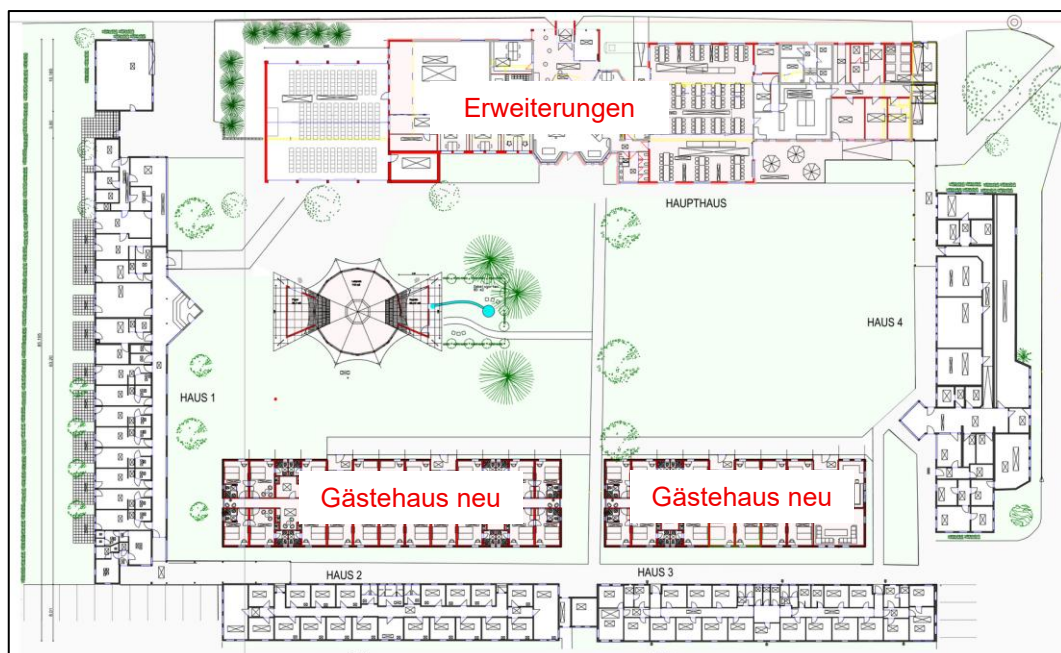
Geplante Erweiterungen und Umbauten, Stand Juli 2025, Quelle: Kirche im Aufbruch
